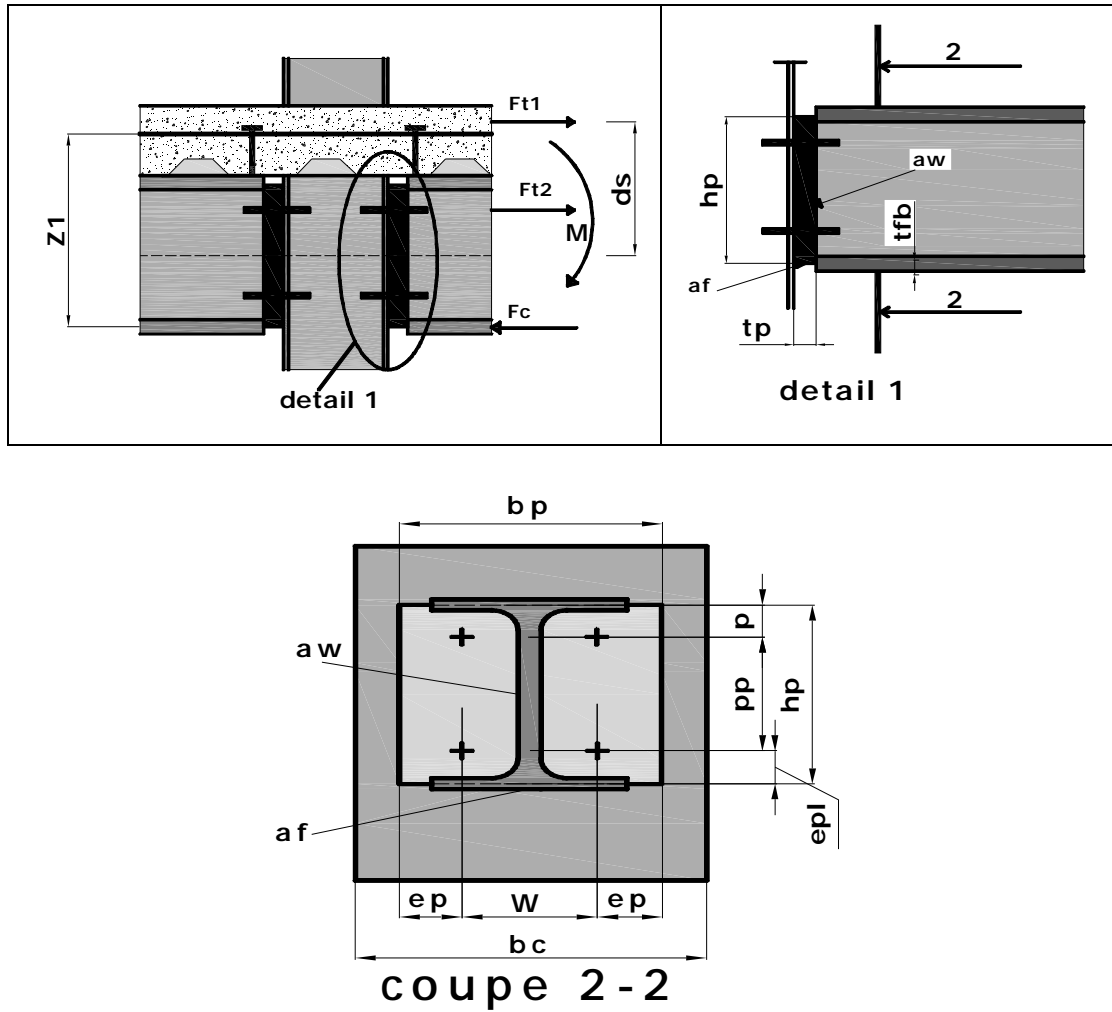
Caractéristiques géométriques d'un Assemblage poutre-poteau par platine d'extrémité non débordante
